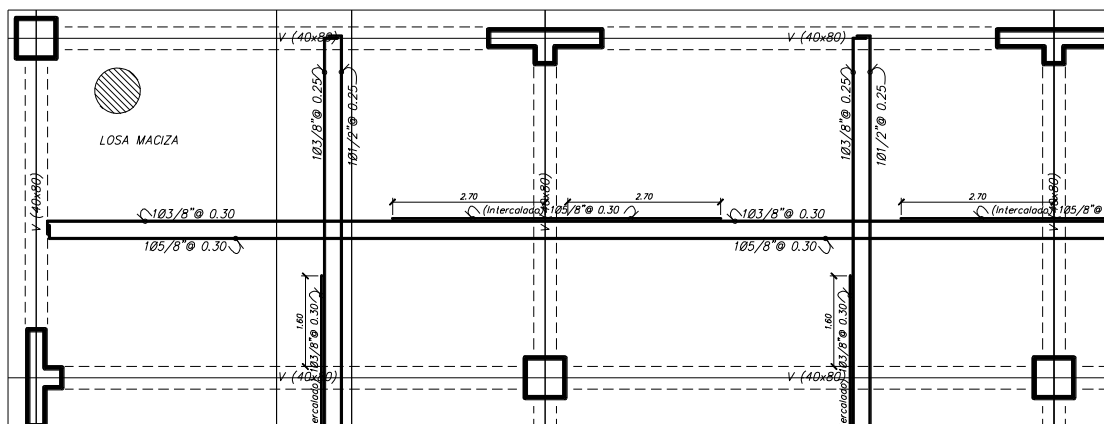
Plano de detalle de losa maciza bidireccional en el nivel de base. (Fuente Propia).
